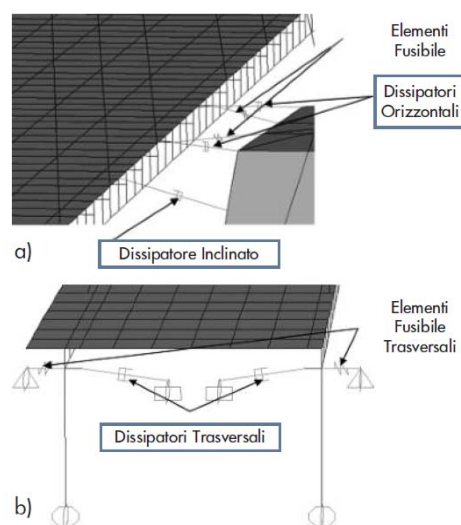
Connessioni con Dissipatori Viscosi: a) Pila-Impalcato - b) Spalle-Impalcato.
